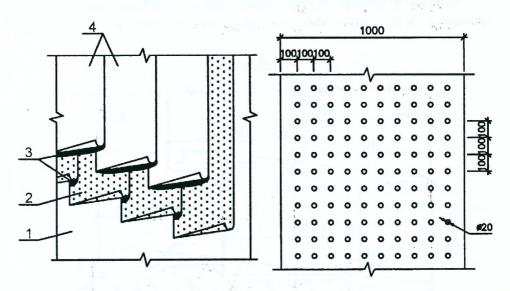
Кровля с нижним слоем из перфорированного рубероида:
